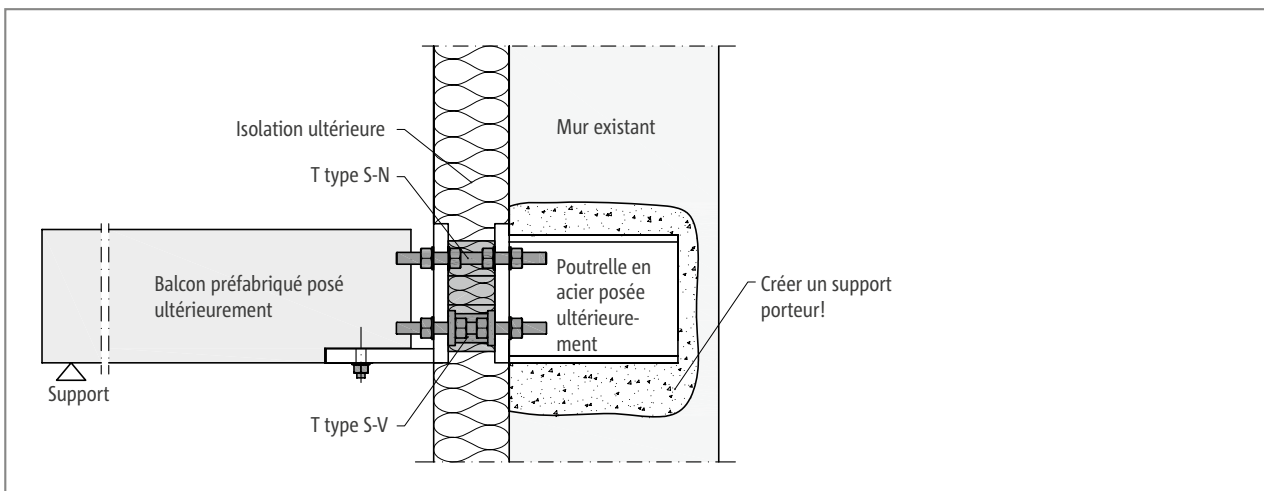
Schöck Isokorb® T type S-N et T type S-V : balcon préfabriqué soutenu posé ultérieurement ; raccordé à des poutres en acier posées ultérieurement avec remplacement
